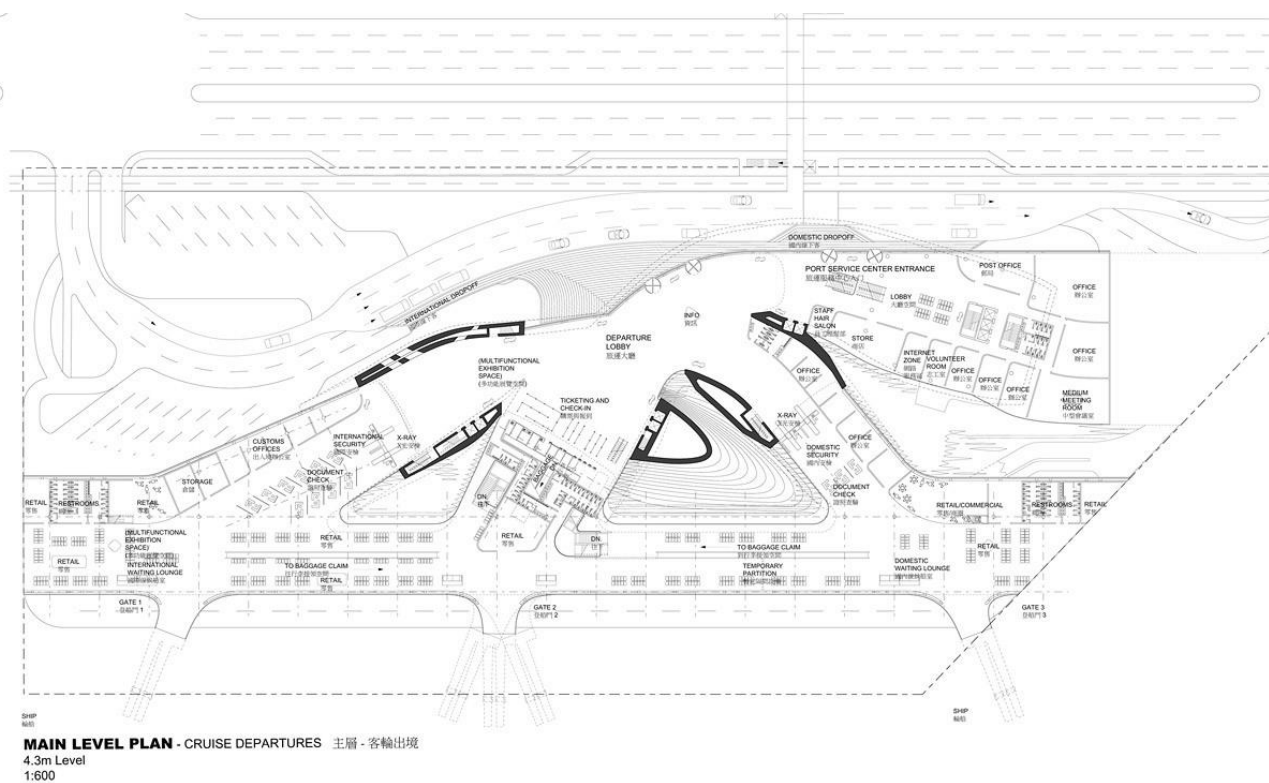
Kaohsiung Port Terminal Reiser + Umemoto [План 1-го поверху з ген планом]
